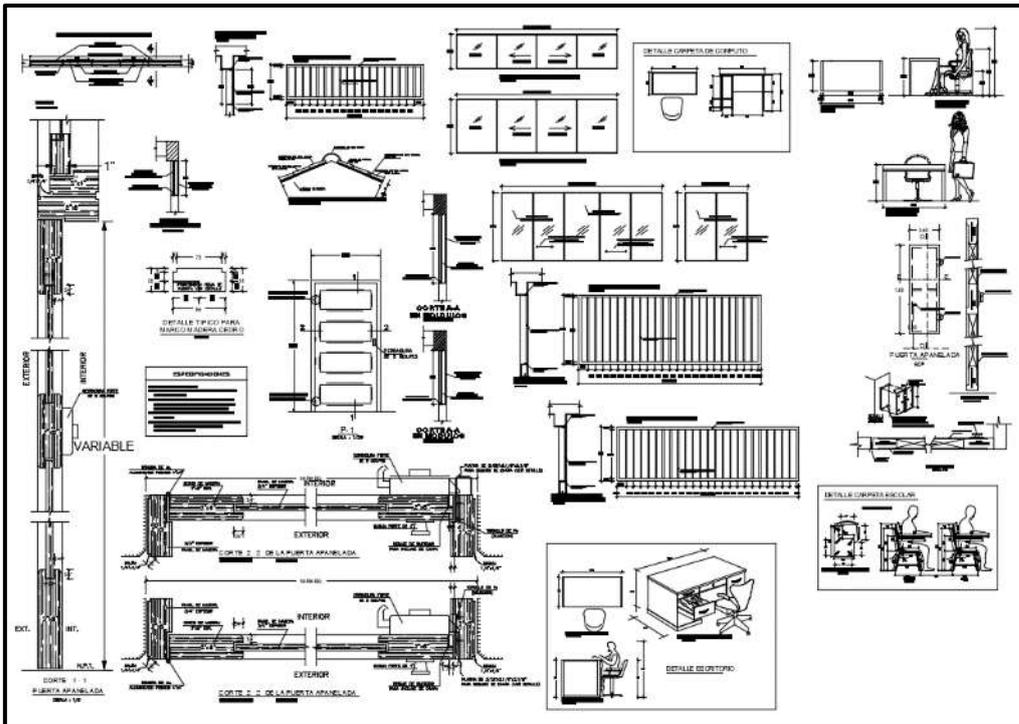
Detalles Arquitectónicos De Puertas Y Ventanas
